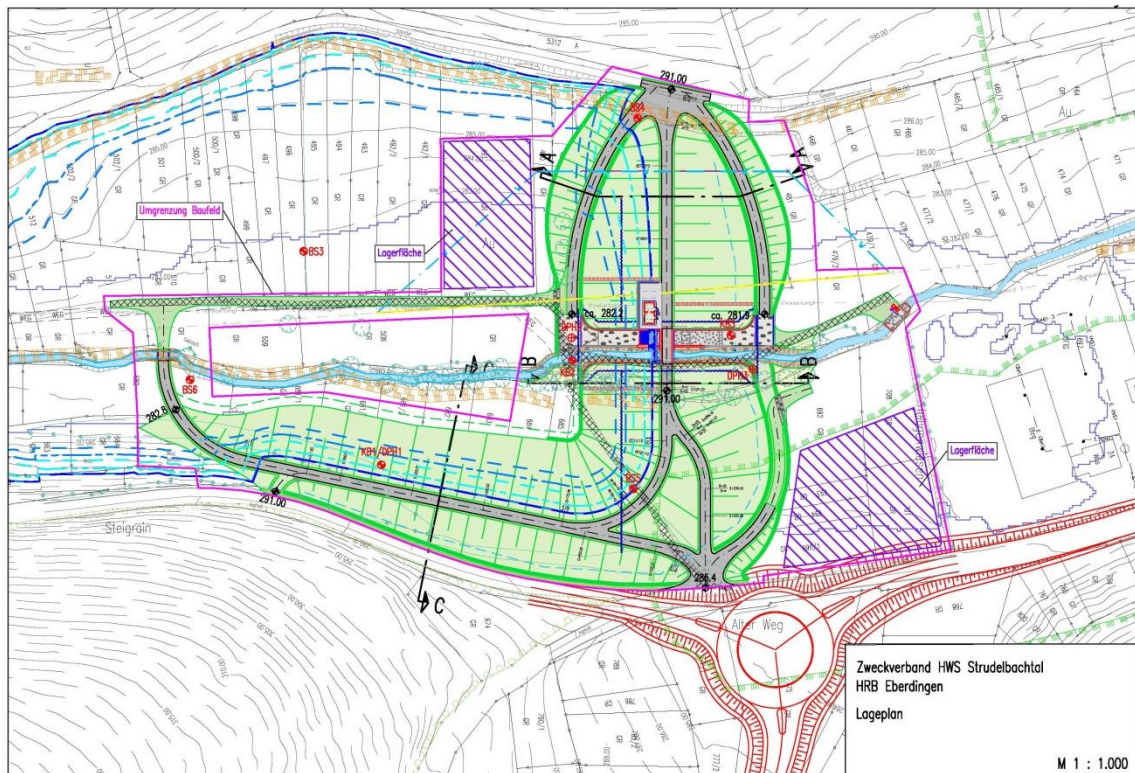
Lageplan der vorgesehenen Baustelleneinrichtungsf lächen
